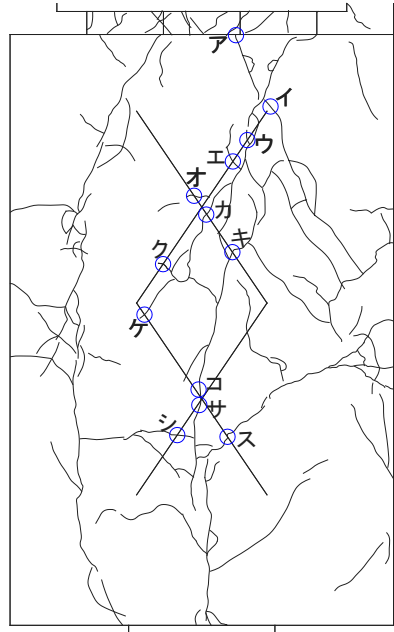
パイルキャップひび割れ幅測定位置 (試験体 A-2 負荷荷)
